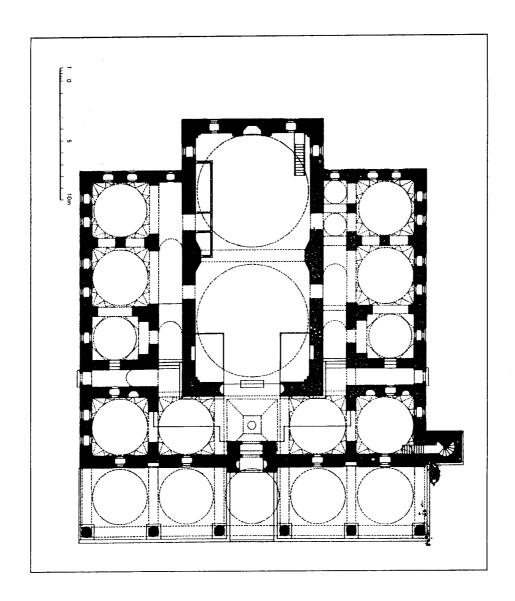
مسقط أفقي لمسجد شهاب الدين باشا في فيلبه (عن : أصلان أبا)
